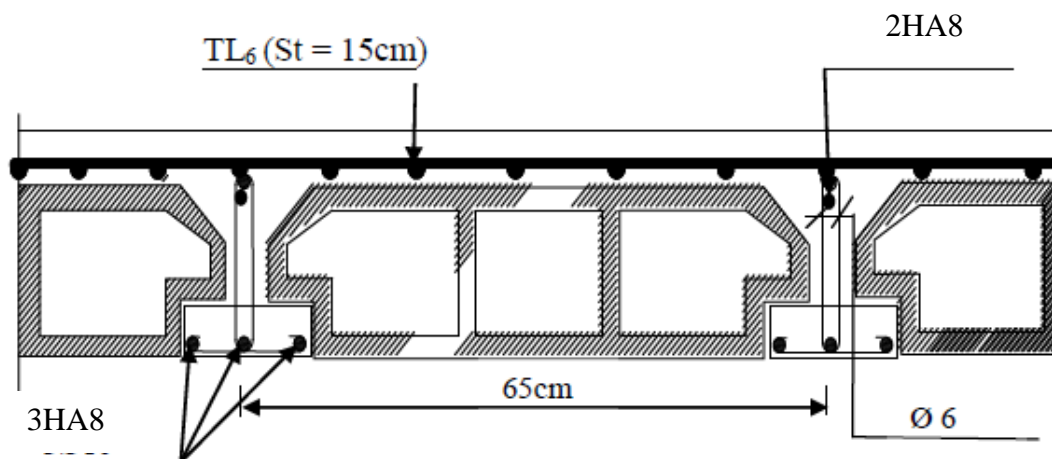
Plan de ferrailage du plancher en corps creux.
